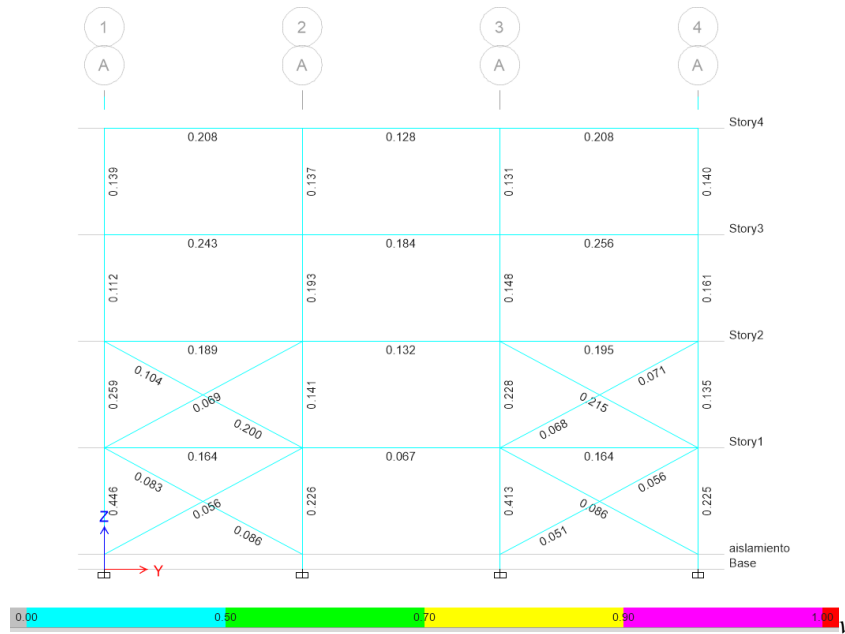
Trabajo de los elementos estructurales sobre eje A, estructura con base flexible, metodología ASCE/SEI-7/16.
